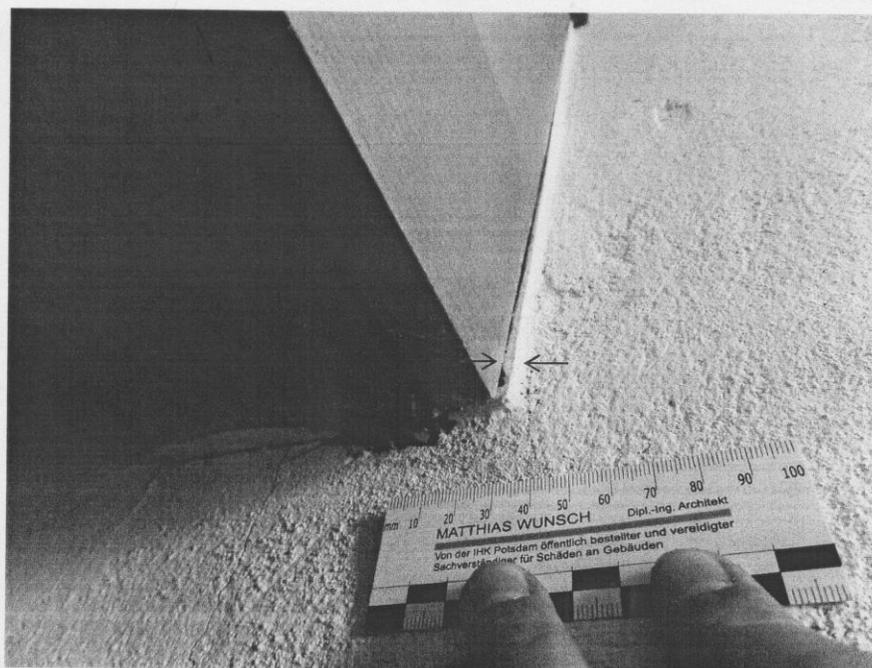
Wandaufleger der Geschossdeckenverkleidung im Obergeschoss, Stirnbrett ist verschoben (Pfeile)
